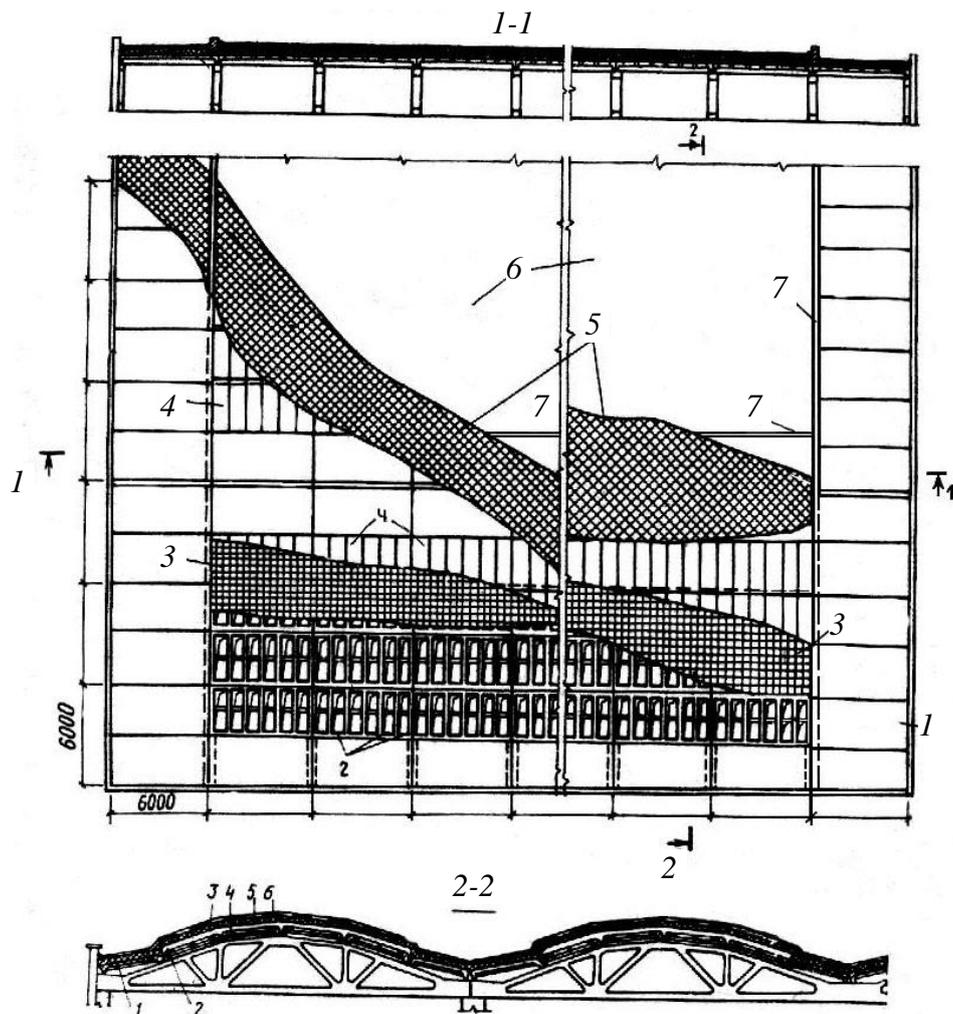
Конструктивная схема устройства легкобрасываемой кровли по сборным железобетонным плитам:
